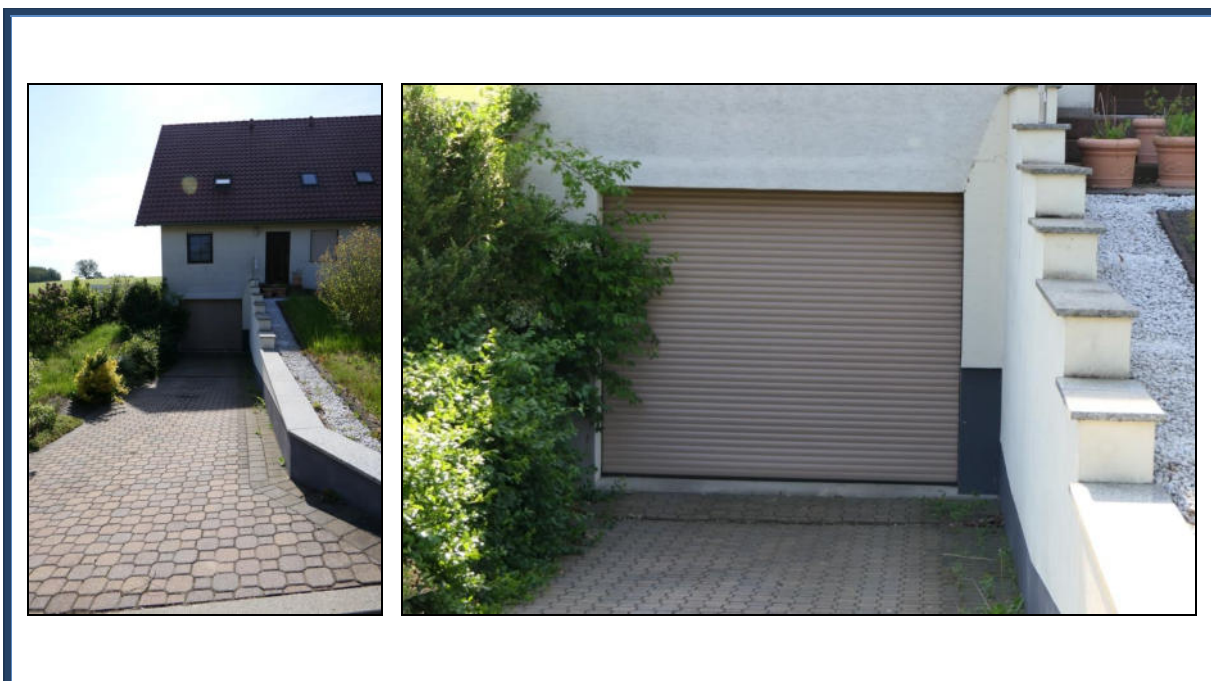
Garagenzufahrt (Gebäudewestseite)
